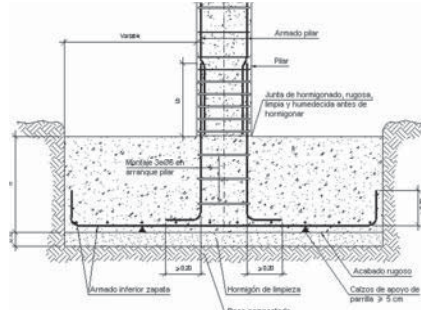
Ejemplo de una zapata aislada de concreto armado de $f'c=250$, se muestra como se ancla un pilar de concreto armado, tomada de la pág. Anteriormente mencionada, también se puede ver con más detalle en el plano de cimentación.
